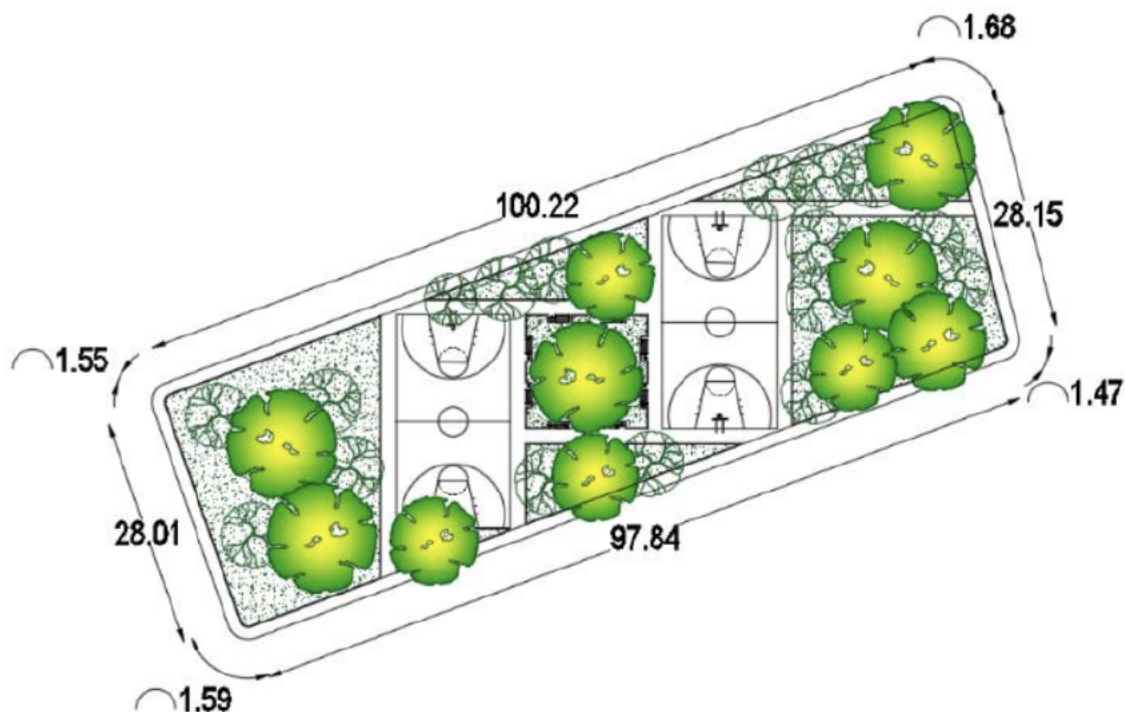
PLANTA DEL "PARQUE DEPORTIVO".
